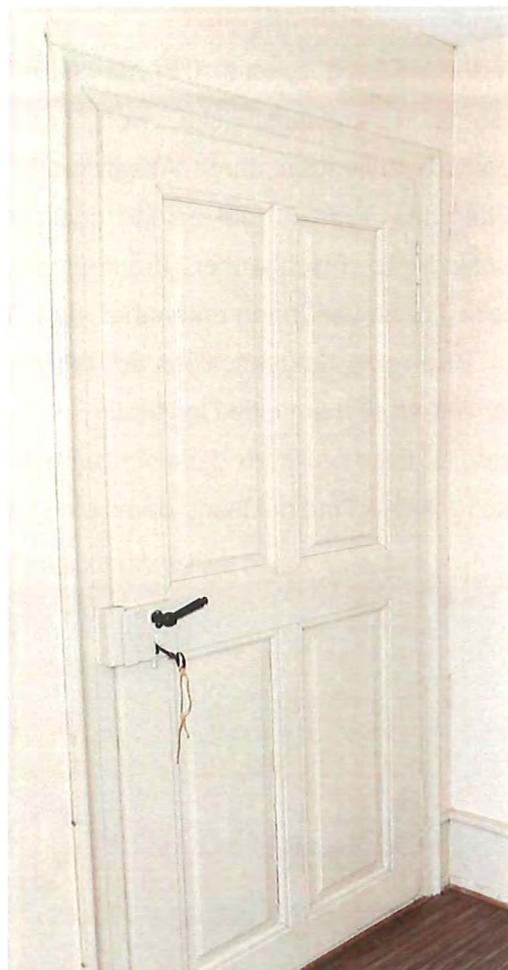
Erdgeschoss, Raum 0.14, Rückseite der Zimmertür mit profilierter Türeinfassung und Tropfenfischband.
